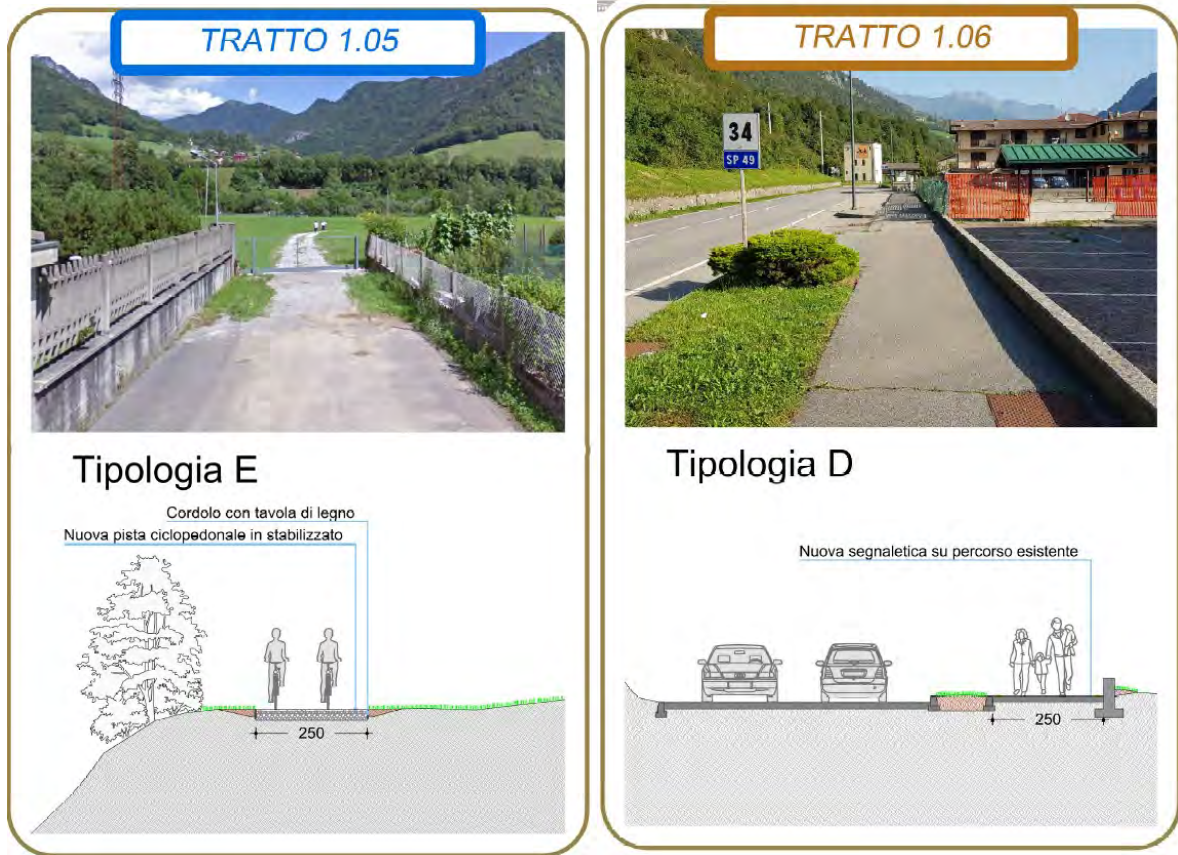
Stralcio delle sezioni tipologiche di progetto
